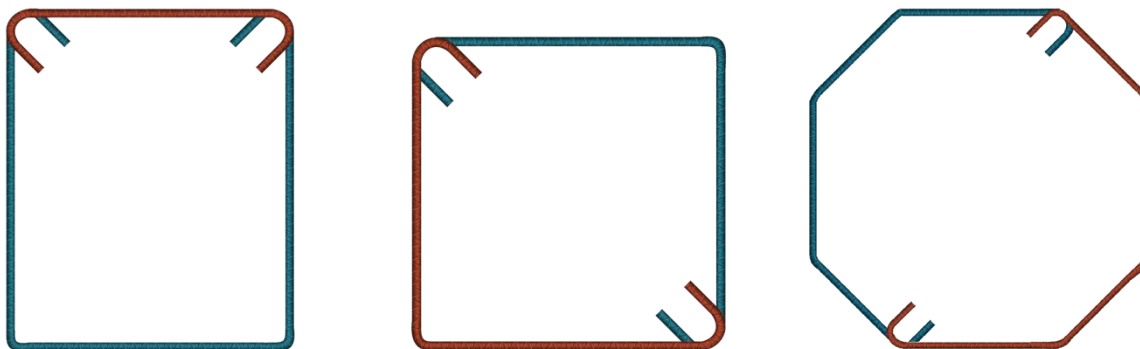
Estribos de dos piezas aceptables para encamisado de concreto
